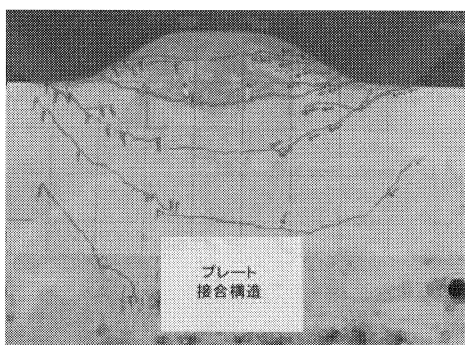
ひび割れ状況 (P 2 供試体)
